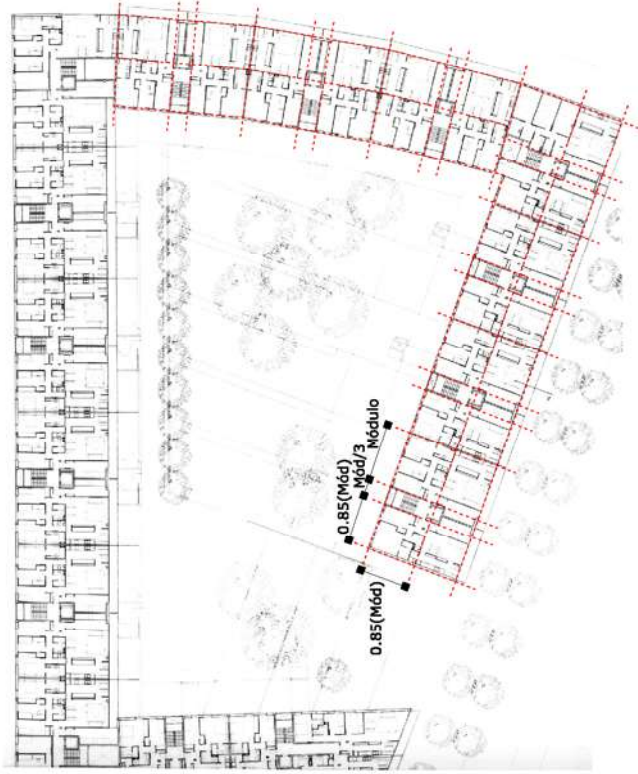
Fragmento Planta Pavimento Tipo E: 1/750
